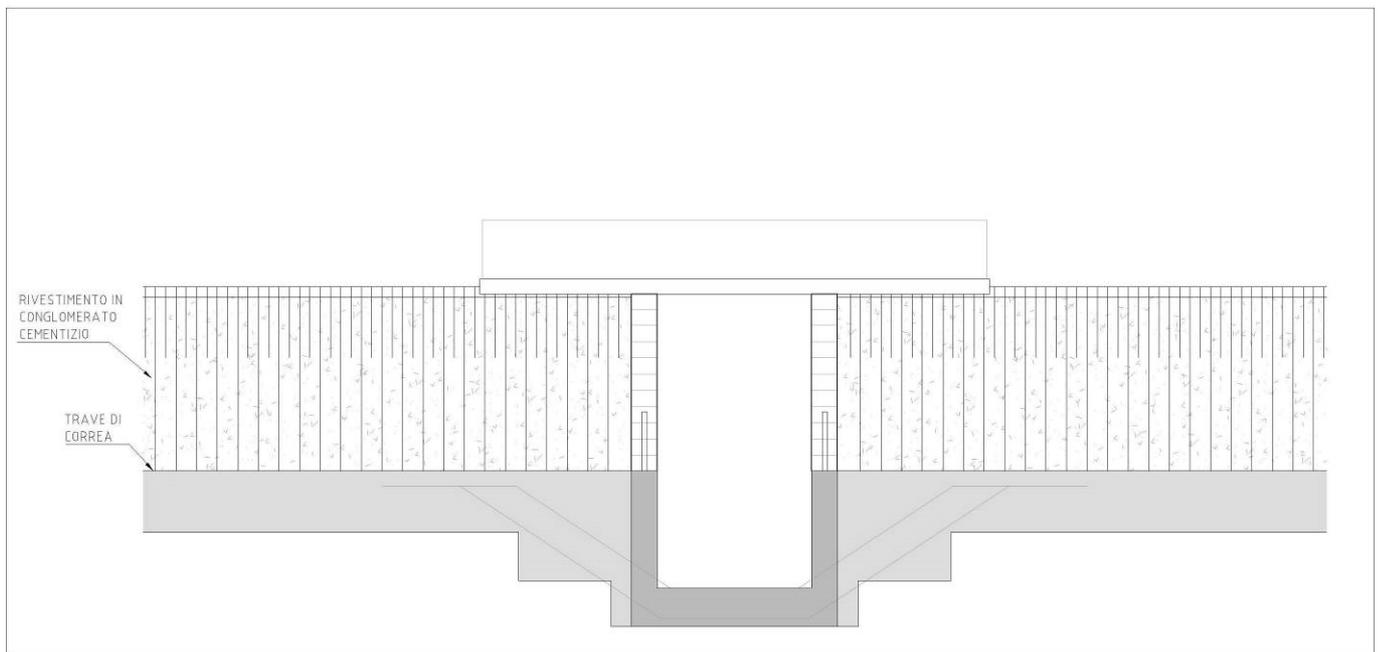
Eliminazione della struttura di copertura delle paratoie della chiavica sul Canale Otto Mulini prevista dal Progetto Esecutivo.
